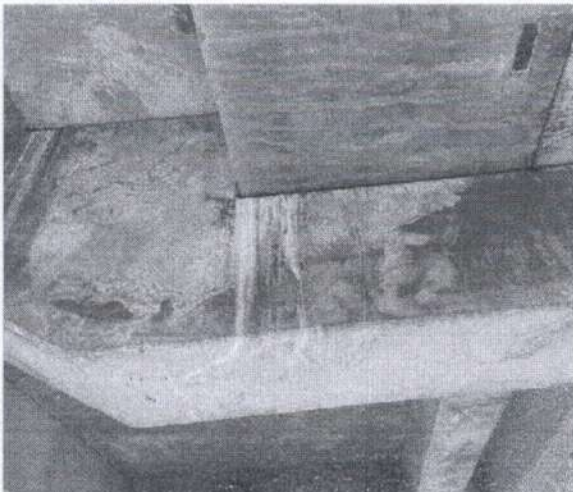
e 4 – Manchas de Infiltração nas vigas pré-moldadas Arquibancada Leste
